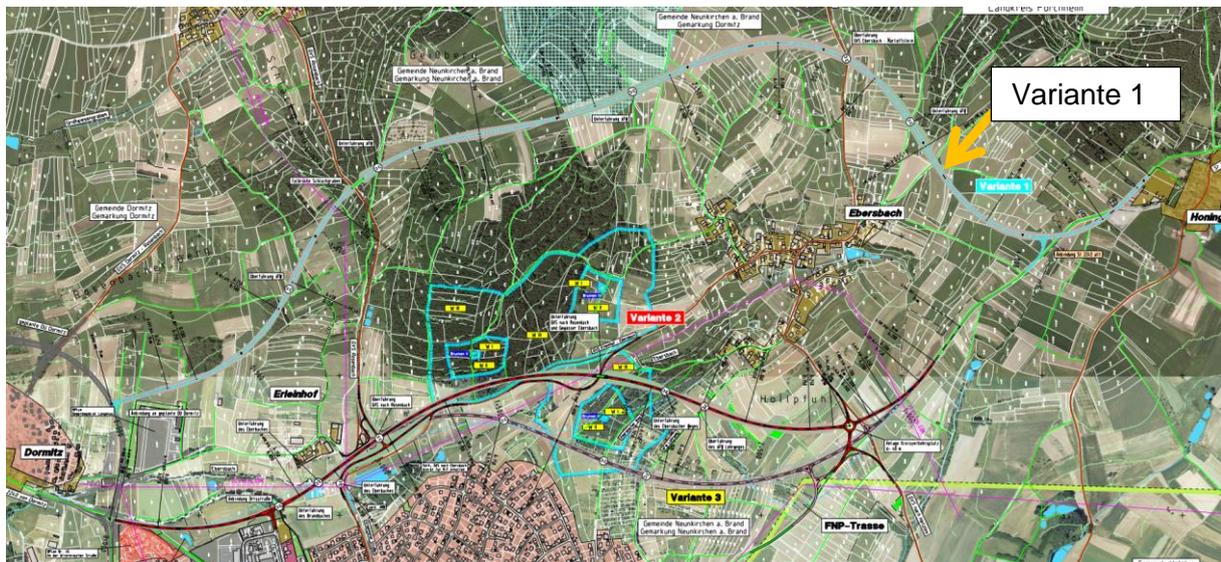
Ausschnitt aus Anlage 1: Lageplan der Varianten im Zuge Vorentwurf
